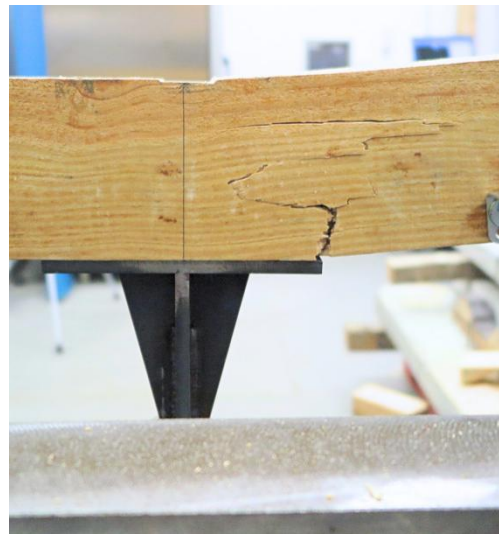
Pormenor da localização dos nós da viga VC2 e local de rotura.
